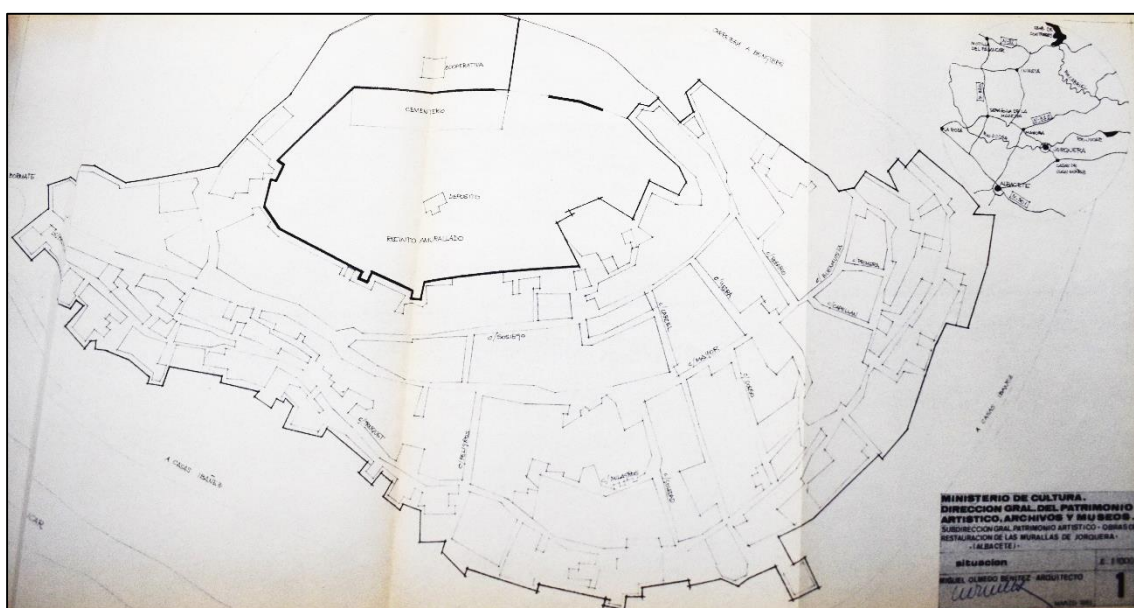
Plano situación. Proyecto de Restauración de las murallas de Jorquera. Fuente: IPCE.
